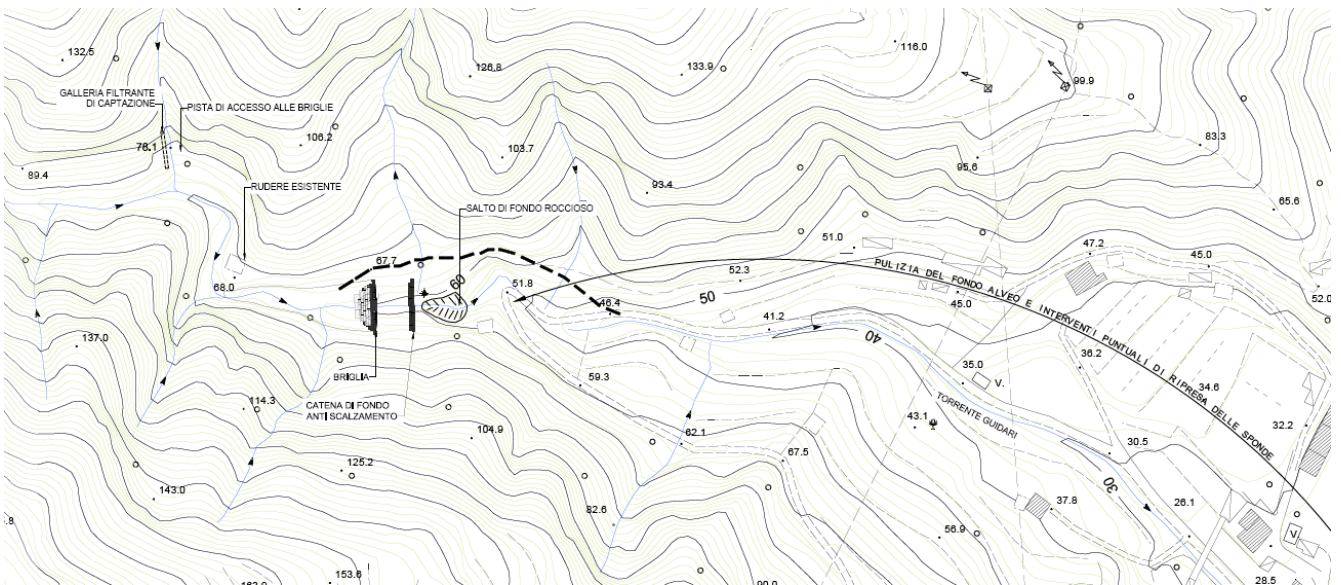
Estratto della planimetria di progetto con l'ubicazione della briglia di sistemazione dell'asta.
